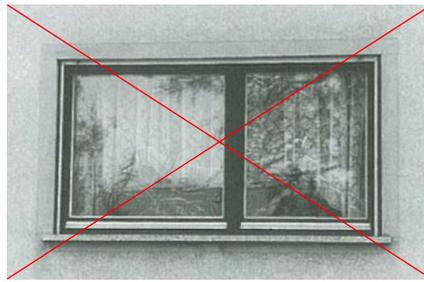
Horizontale Fensteröffnungen stören empfindlich das Gesamtbild der Fassade.
